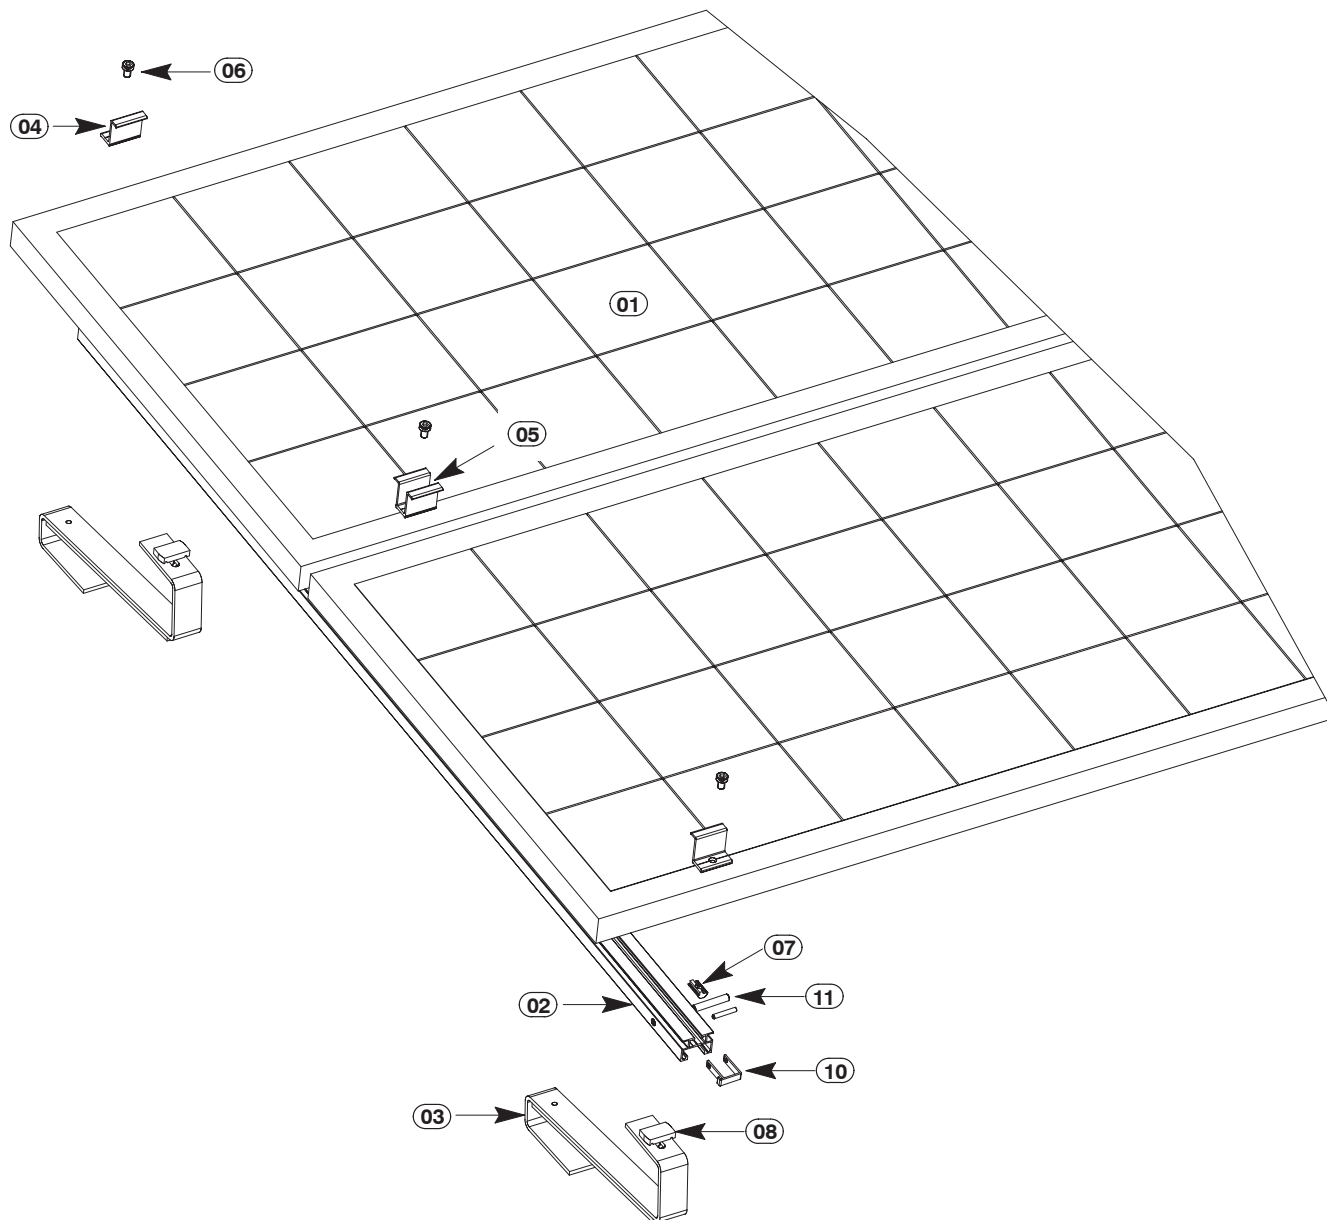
Montage en appui des capteurs PV horizontaux en bande verticale, système PV-Light
